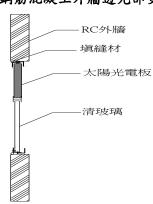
鋼筋混凝土或鋼板外牆構造整合光電板應用之方式
